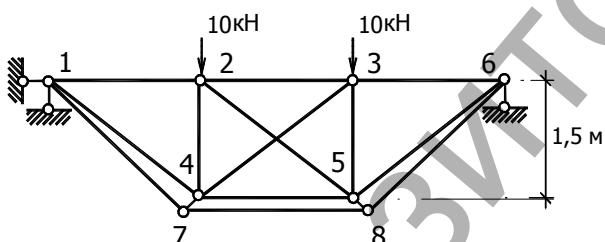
Расчетная схема фермы со смещенной затяжкой
